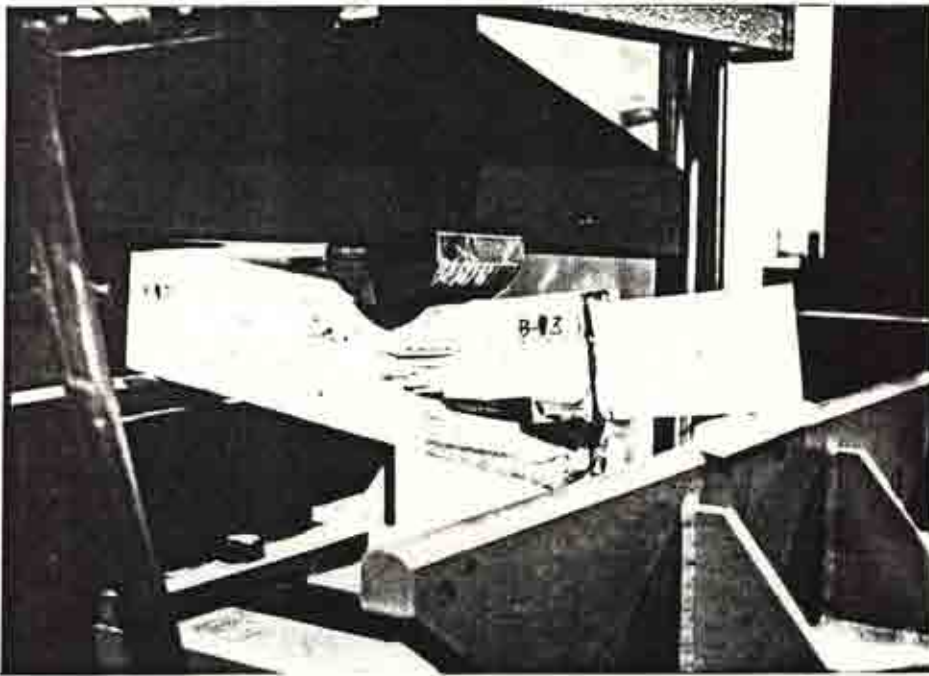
Momento de la rotura en un ensayo de viga con refuerzo de placa en apoyo. Fallo por cortante de la madera.
